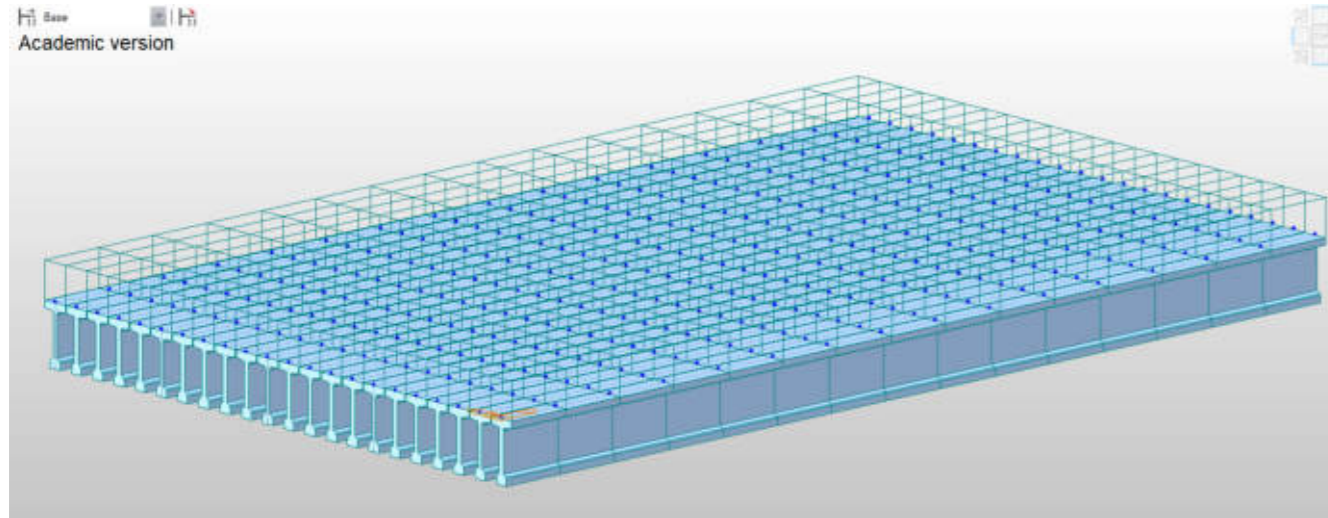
Modelado de barras con sección de viga canto 40 cm del tramo 1
